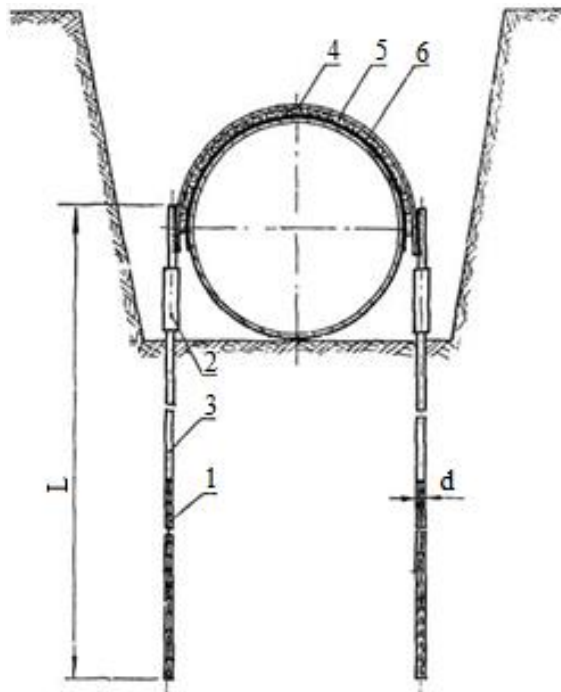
Точечное закрепление трубопроводов анкерными устройствами
